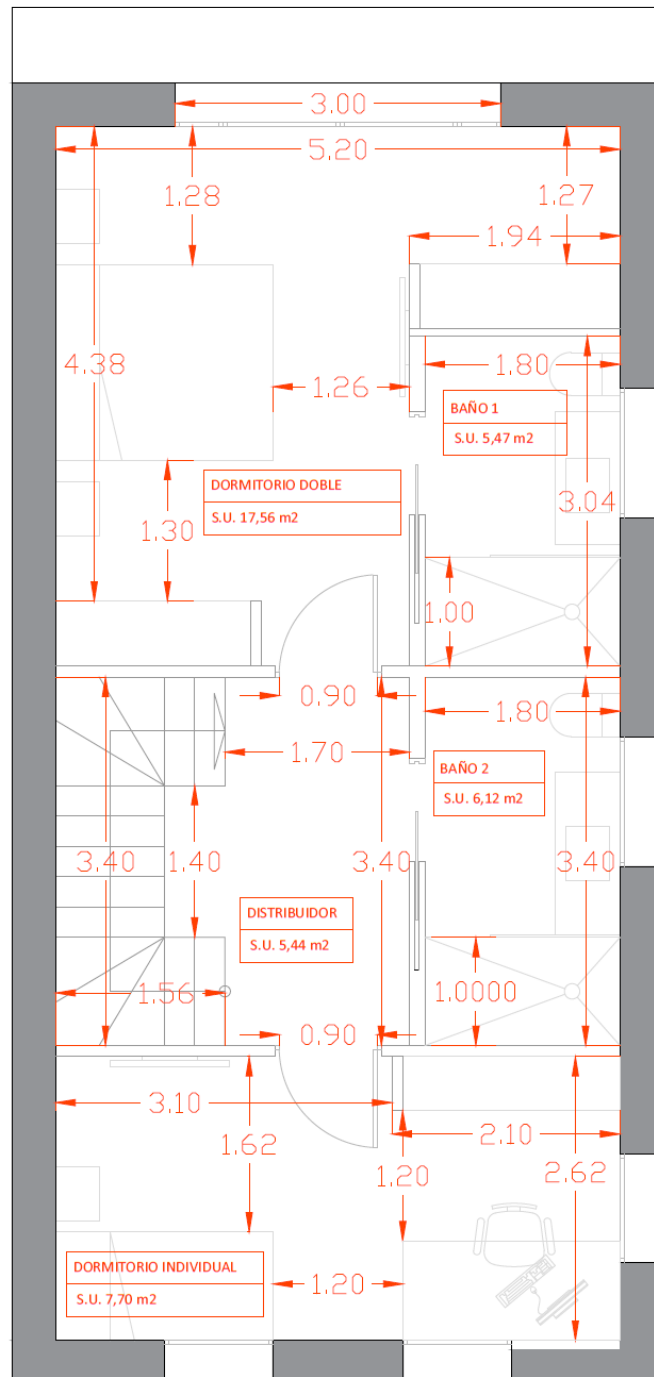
Plano superficies planta primera 2019. Fuente propia.
